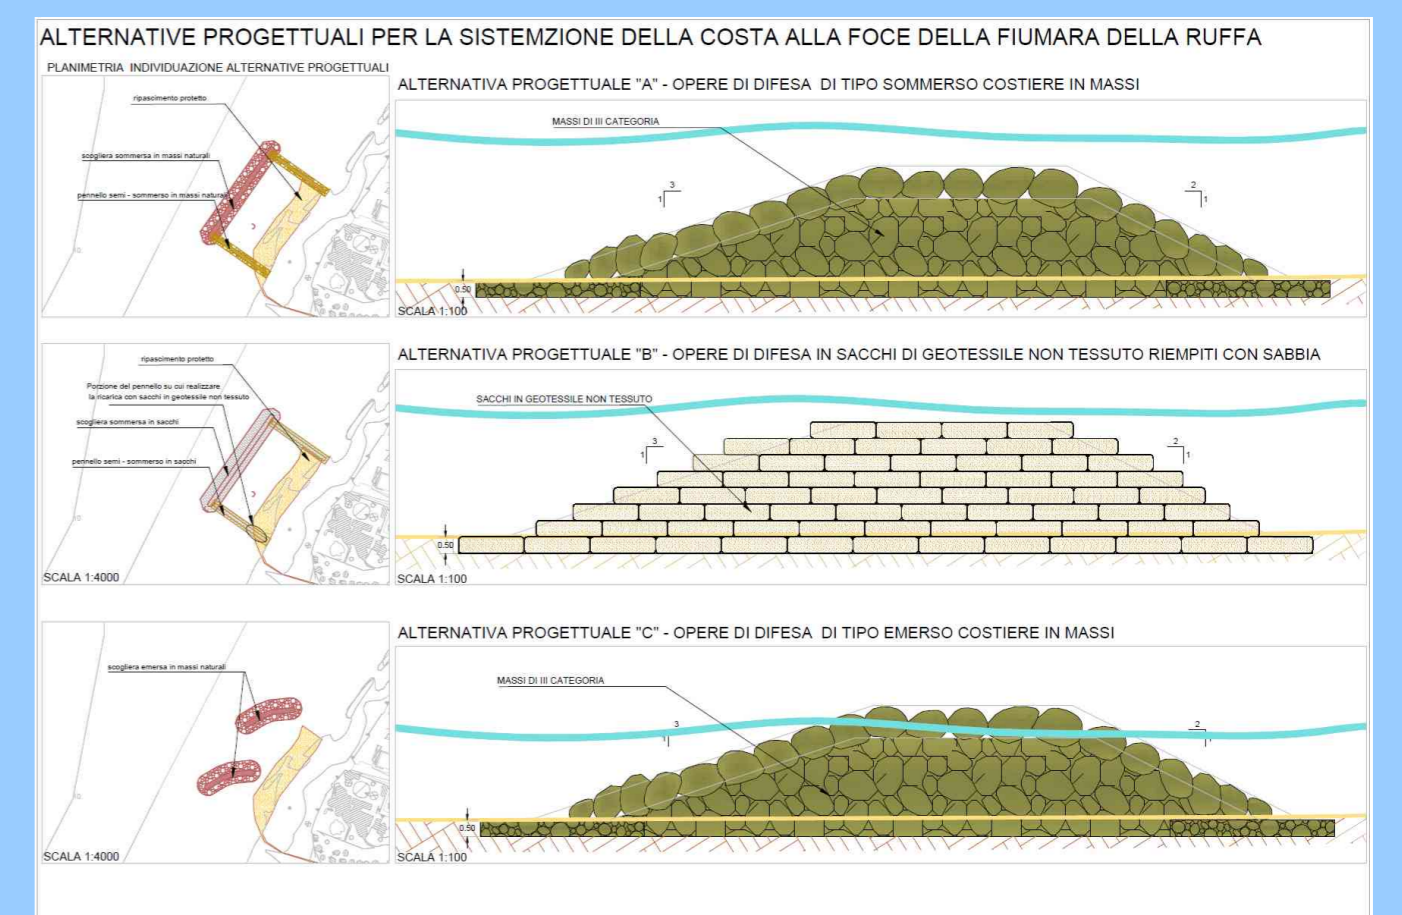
planimetria e sezioni delle alternative progettuali proposte
